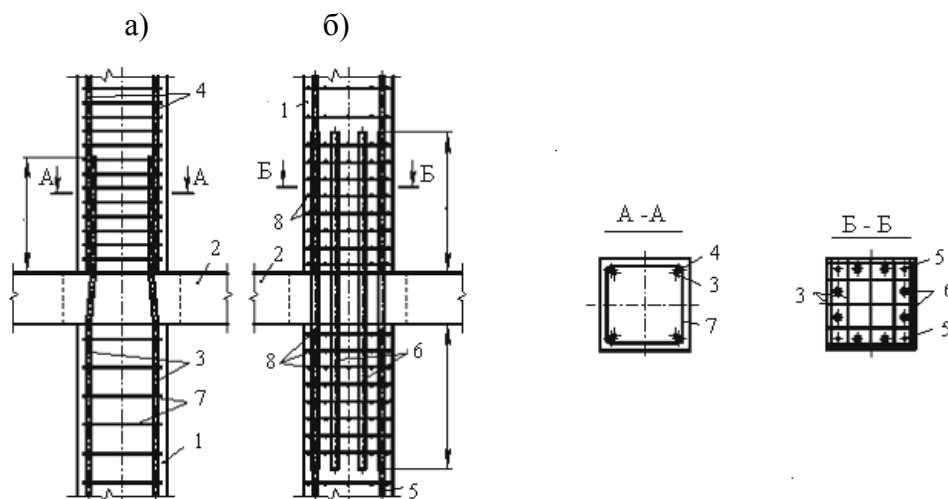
Варианты конструкции стыков монолитных колонн с дисками перекрытий
